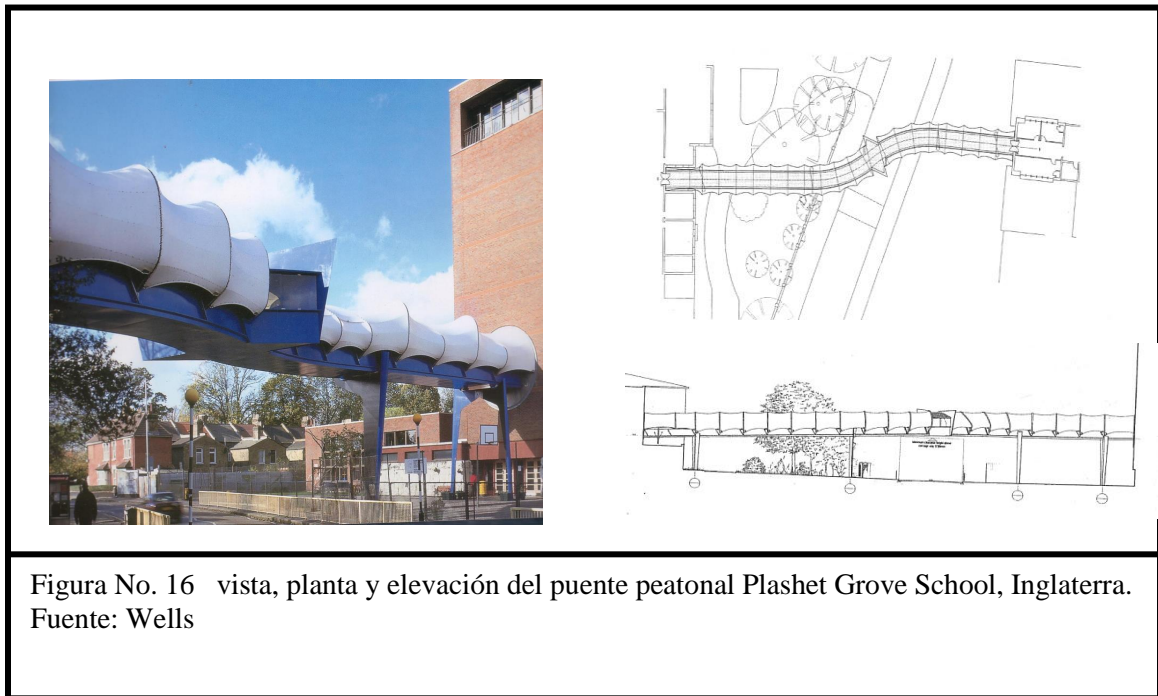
vista, planta y elevación del puente peatonal Plashet Grove School, Inglaterra.
